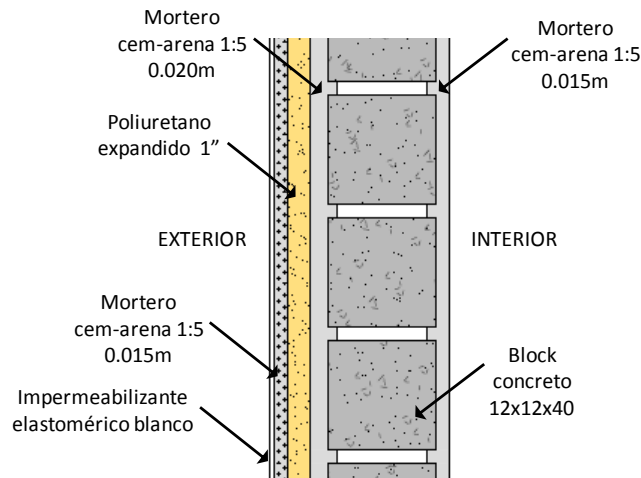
Corte esquemático del aislamiento con poliuretano esparcido de 1" y pintura blanca en muros exteriores de la fachada sur (caso prototipo post-construcción)
